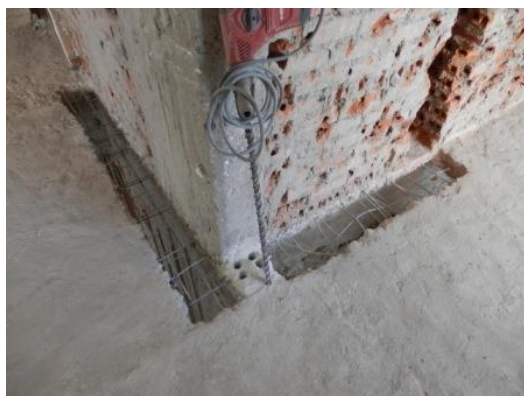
Demolição parcial da laje para atravessamento da armadura
